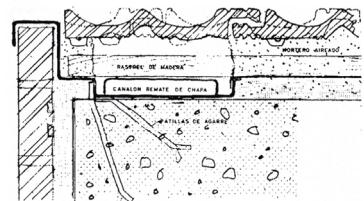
Casa Huarte. Encuentro de faldón de cubierta con plano de fachada. Fotografía: A. L. Baltanás
